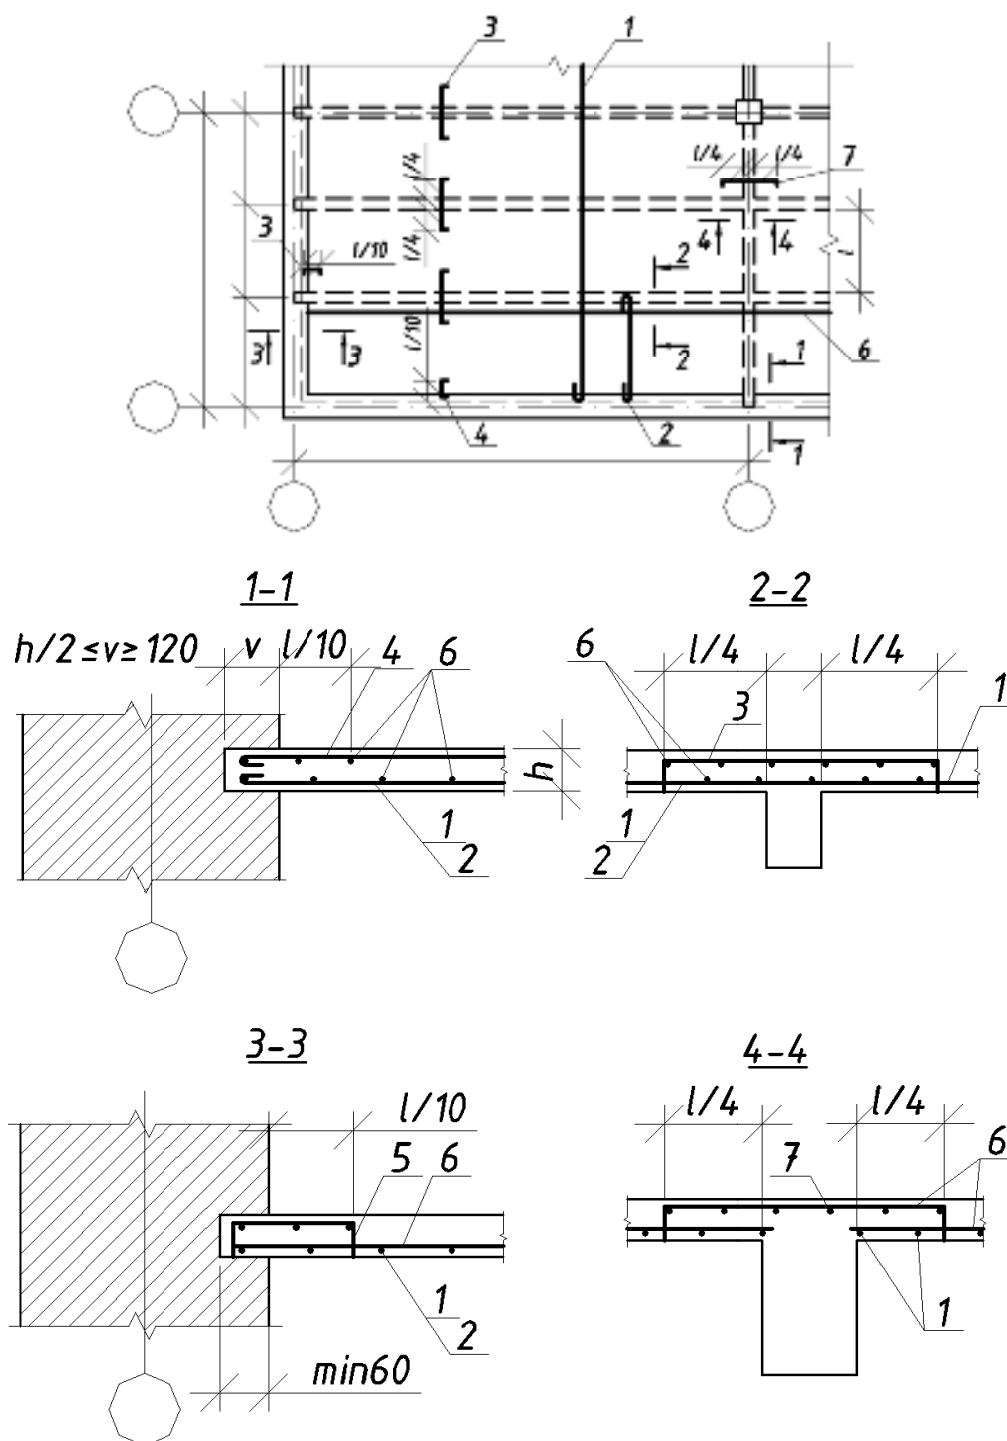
Раздельное армирование монолитных балочных плит отдельными стержнями: 1, 2 – пролётная арматура в рабочем направлении; 3, 4 – надпорная арматура в рабочем направлении; 5, 6 – арматура в нерабочем направлении
